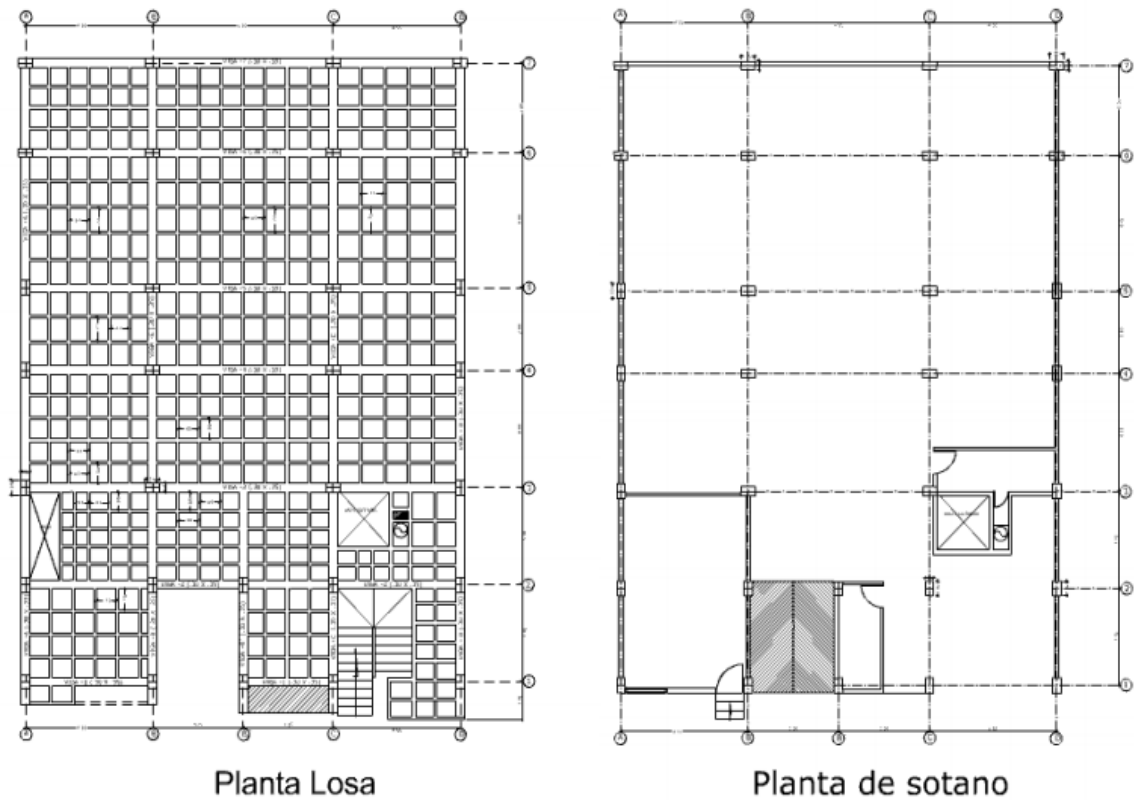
98 Ejemplificación de Planta de losa y Planta de sótano.
